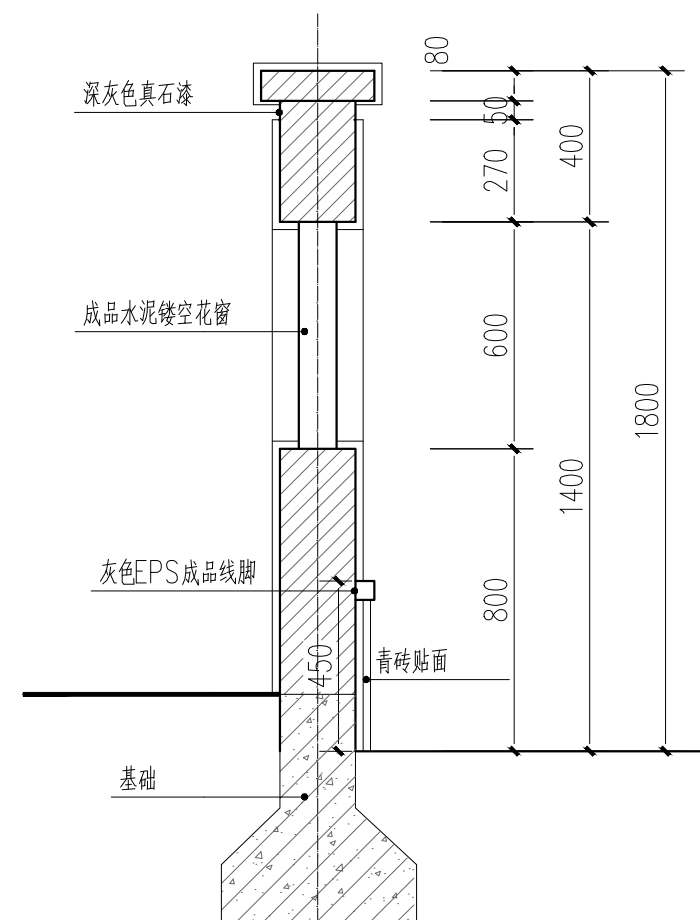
围墙大样	图纸编号	建详-16	建筑
